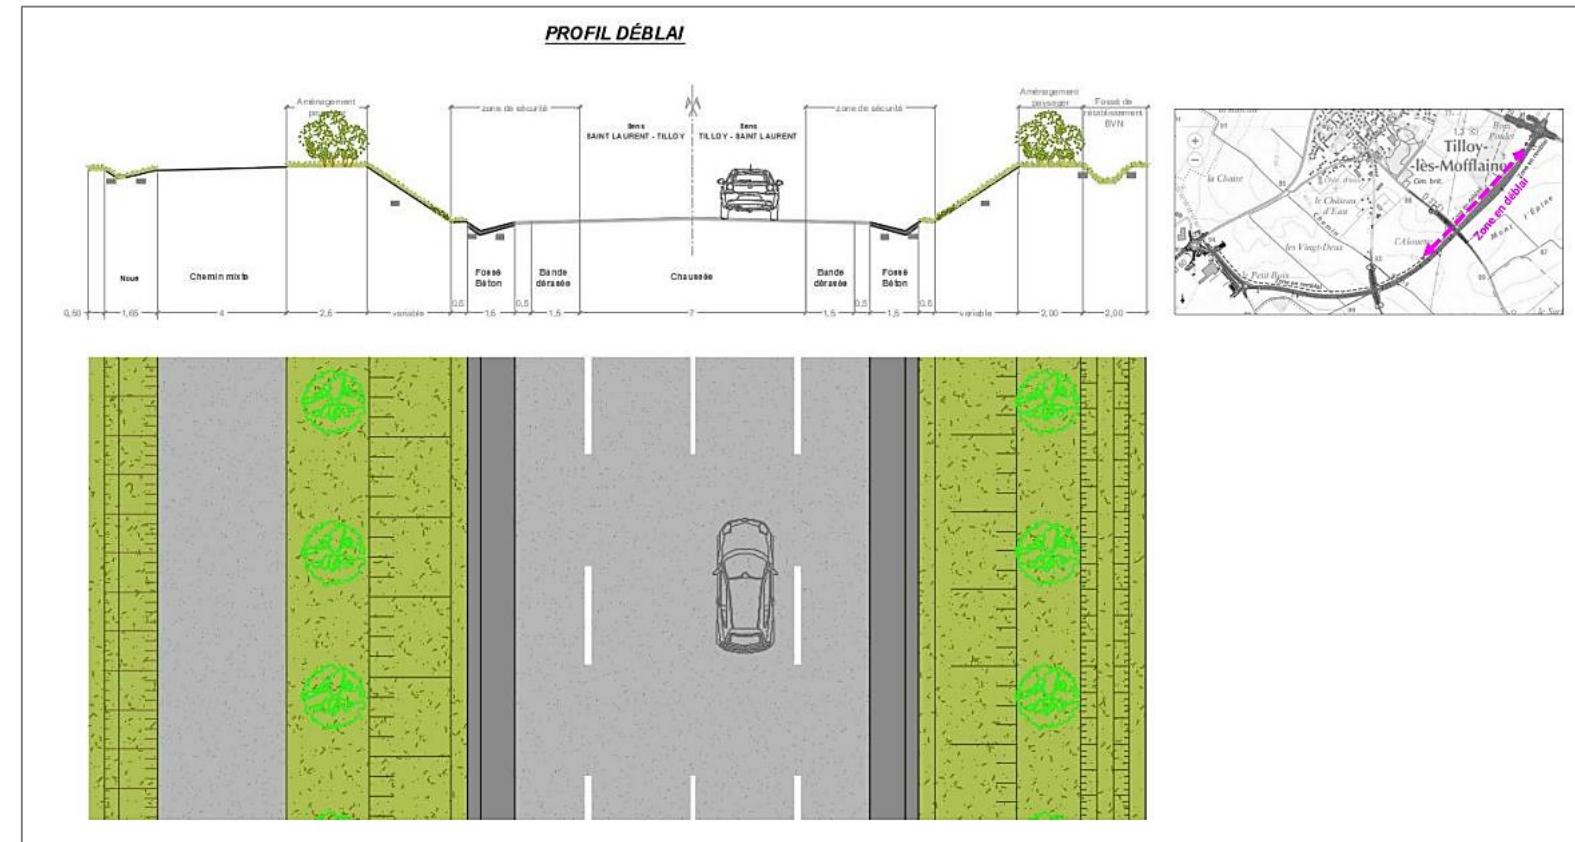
Profil travers de la section courante - en déblai avec et sans merlon
